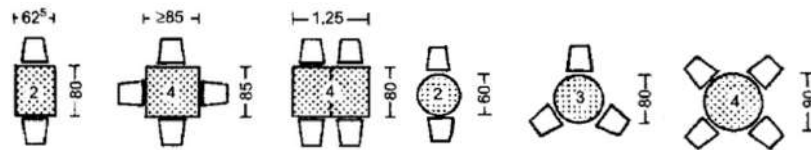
Standar Layout Kursi dengan Meja Bulat
